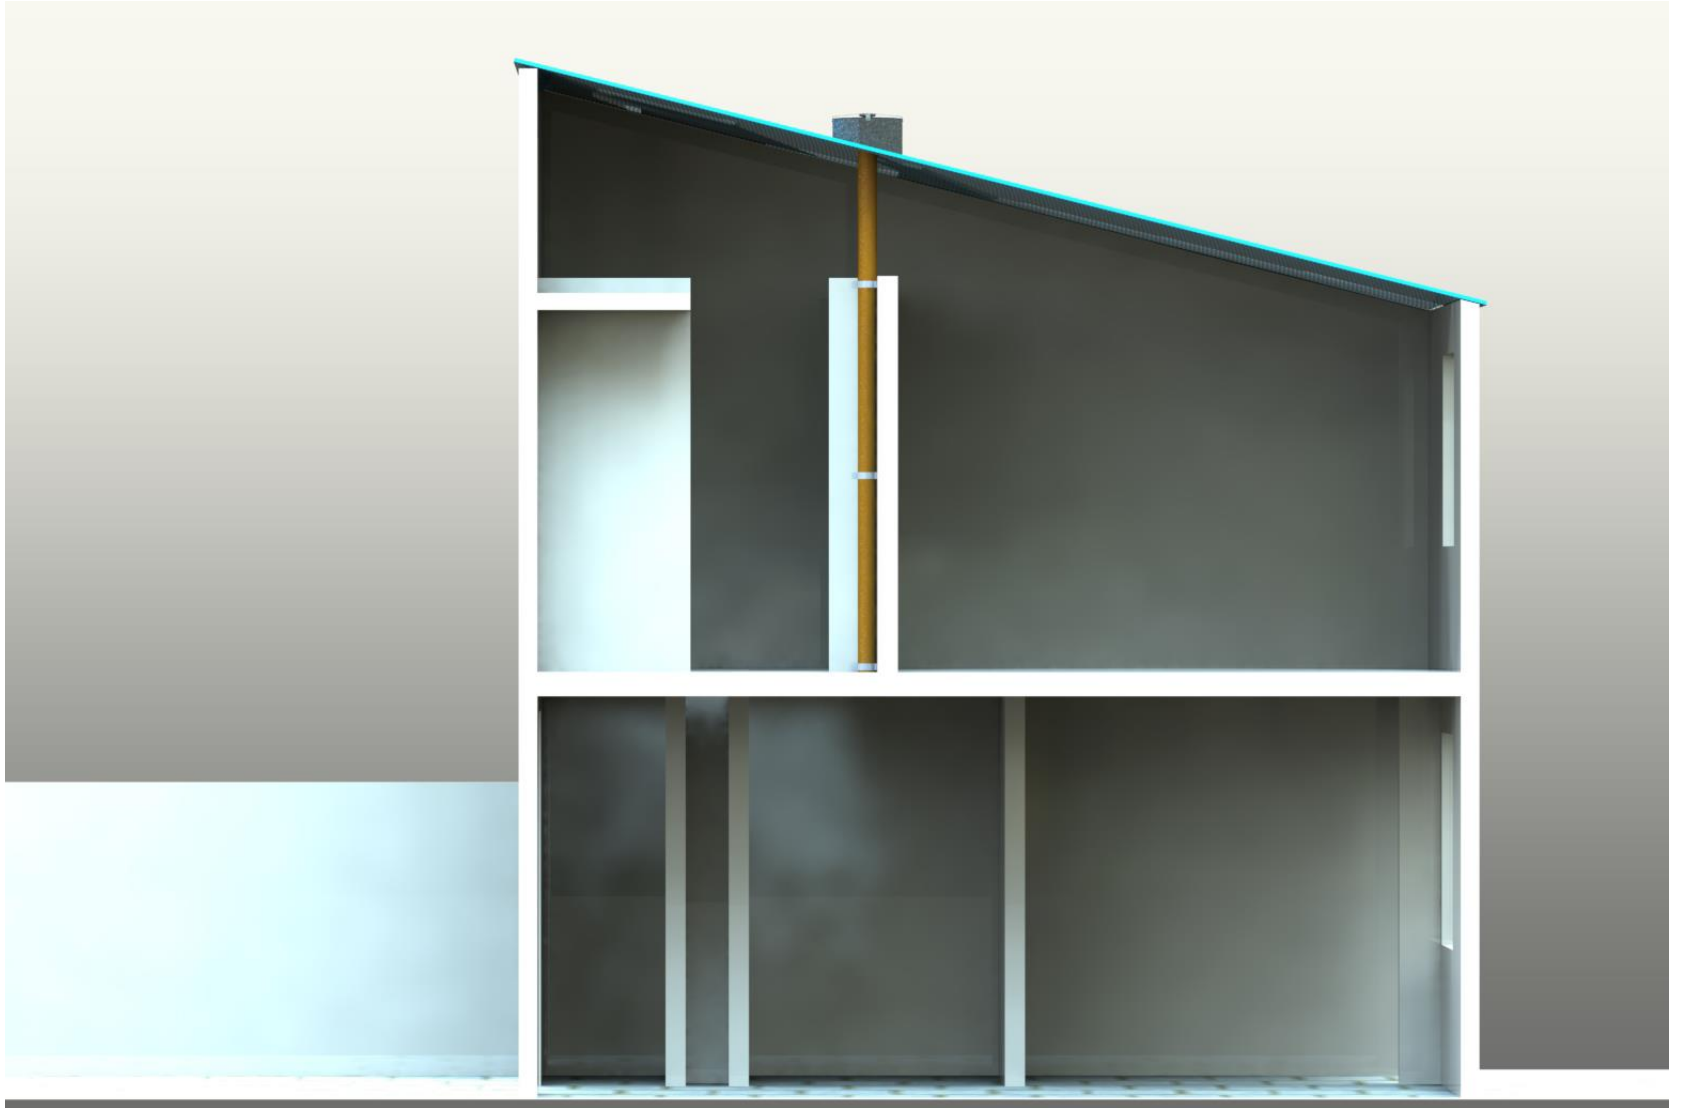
Vivienda con Solux instalado. Fuente: Autora.
